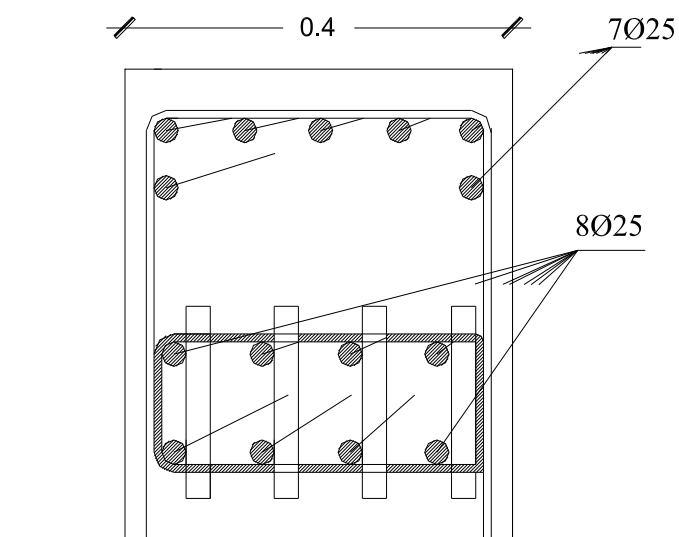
Pormenorização da armadura exemplo de VAY (2)
